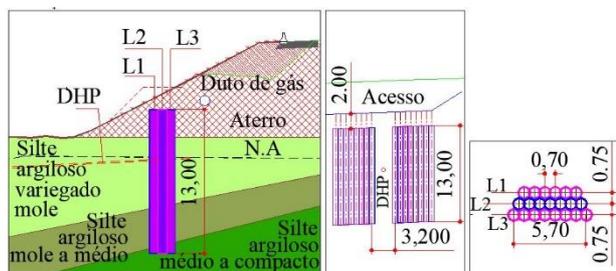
Bloco de Jet Grouting - seção e detalhes.
